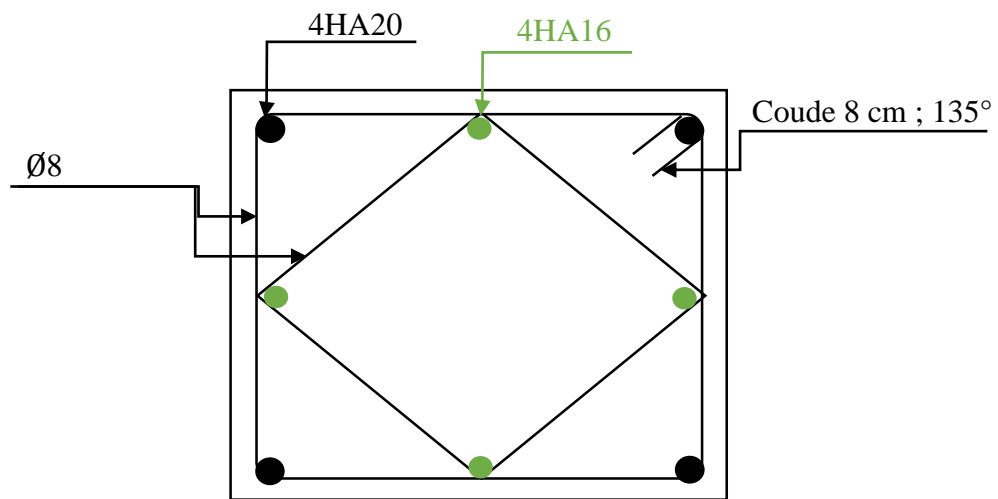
Schéma de ferrailages du poteau du RDC.
